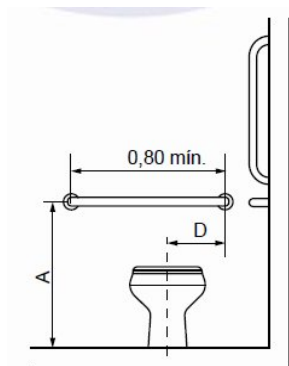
Vista frontal - Instalação de barras horizontais e verticais.
